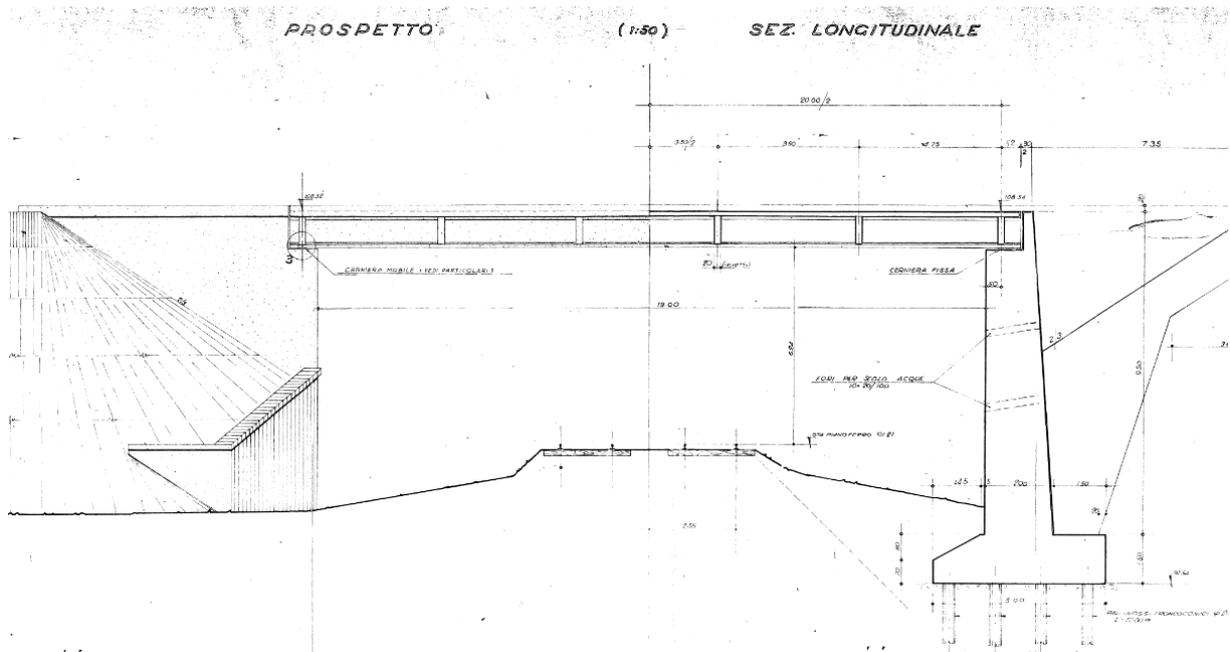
Pianta/Sezione longitudinale dell'attraversamento storico.
